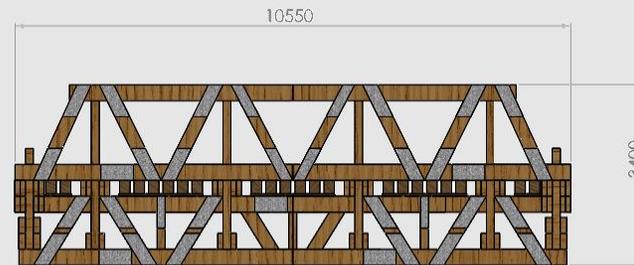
Vista Longitudinal del puente Allipén (10 m).
